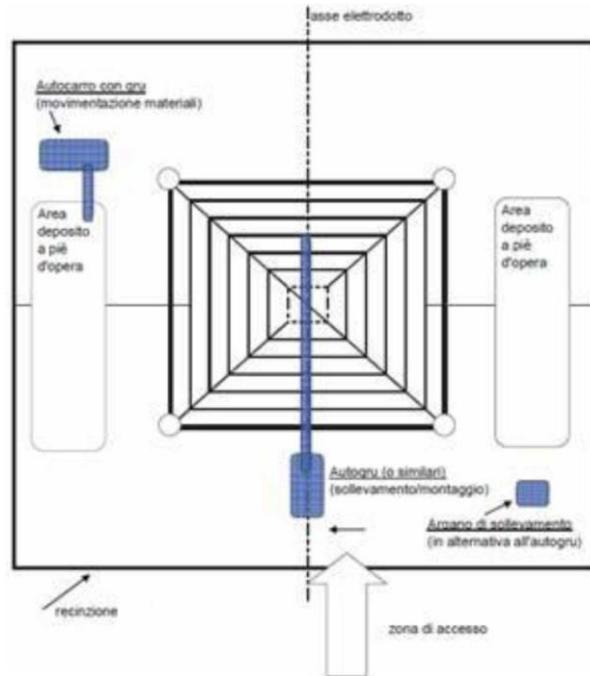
Planimetria tipologica di un microcantiere nella fase di montaggio del sostegno.
